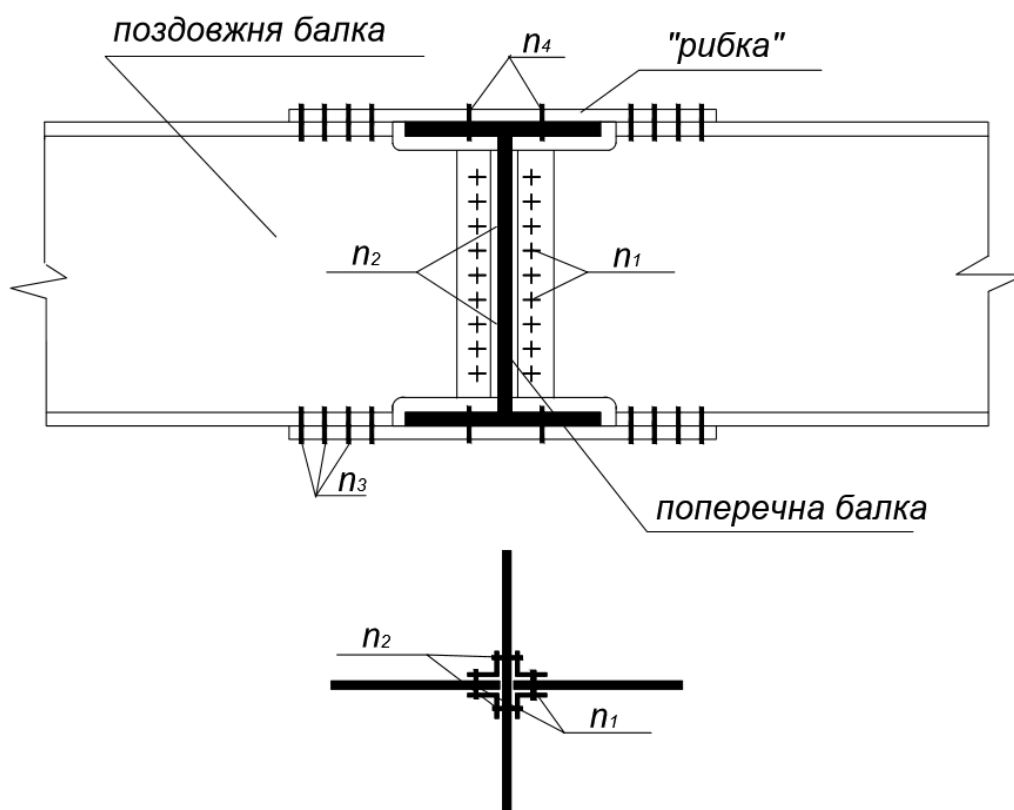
Прикріплення поперечної балки до поздовжньої
